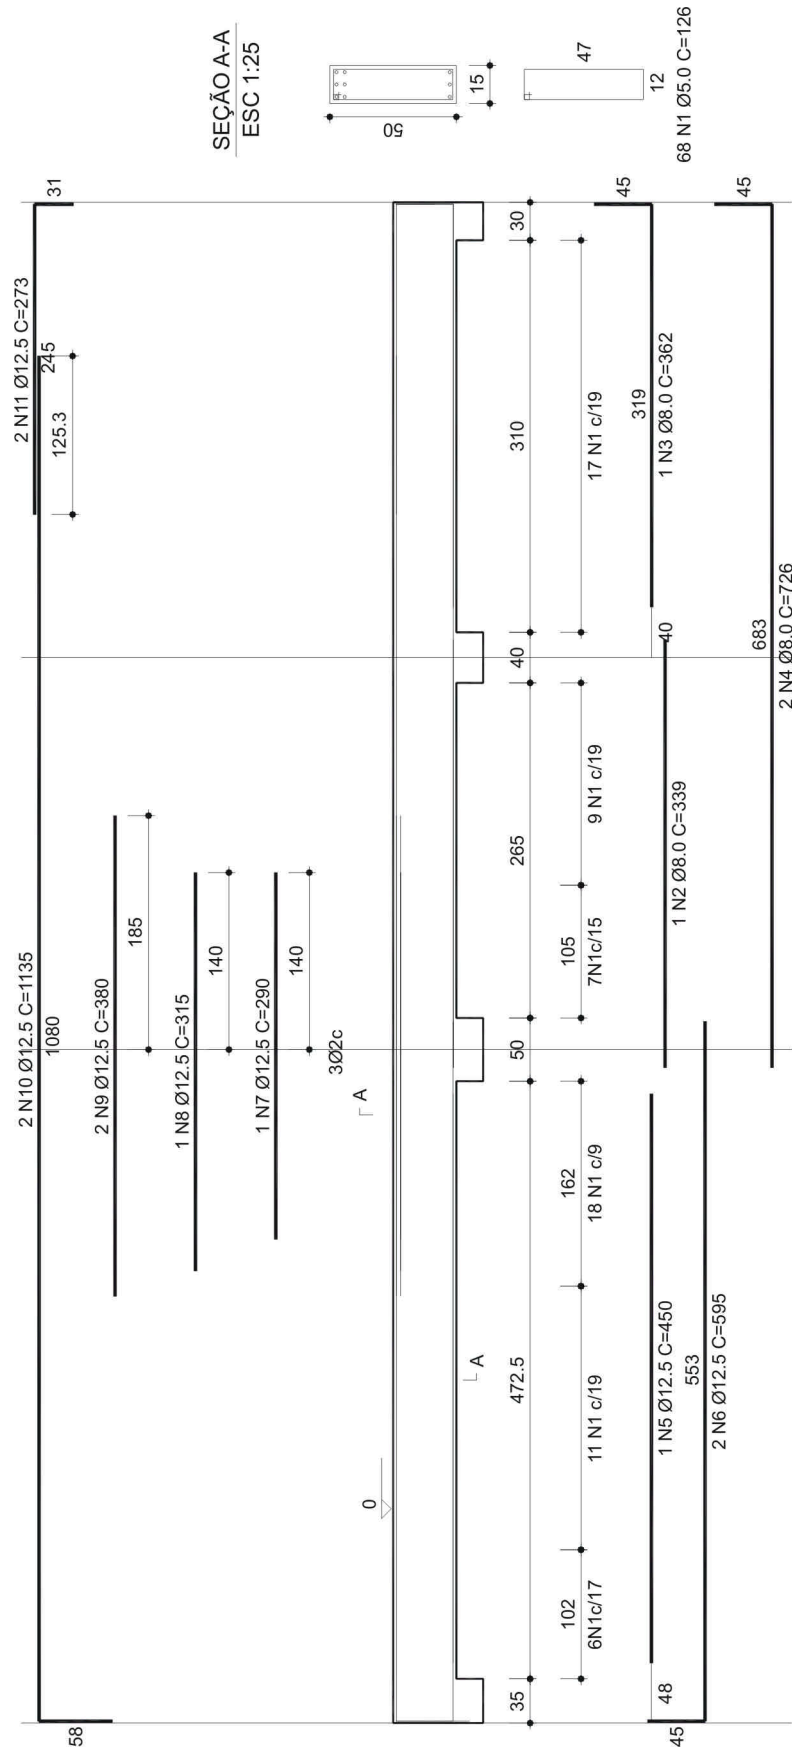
Detalhamento Viga 04., realizado pelo Eberick.
